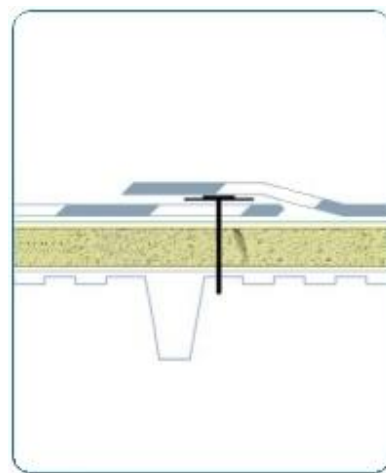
a. Sección de la cubierta tipo Deck.
